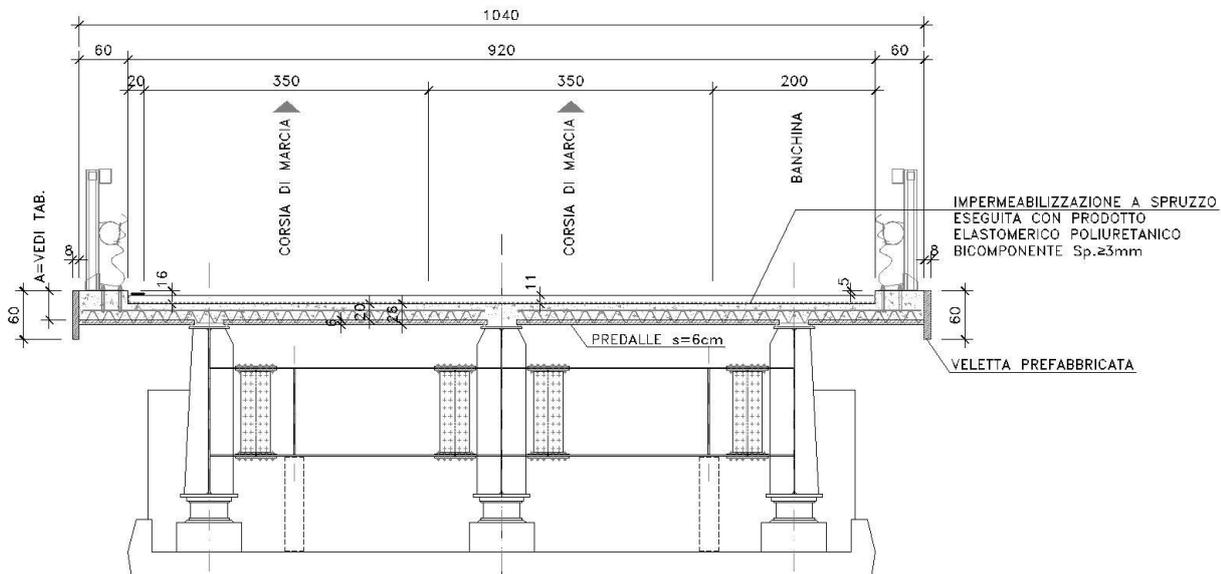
Sezione trasversale nuovo impalcato a 3 travi – Sezione in asse appoggi
